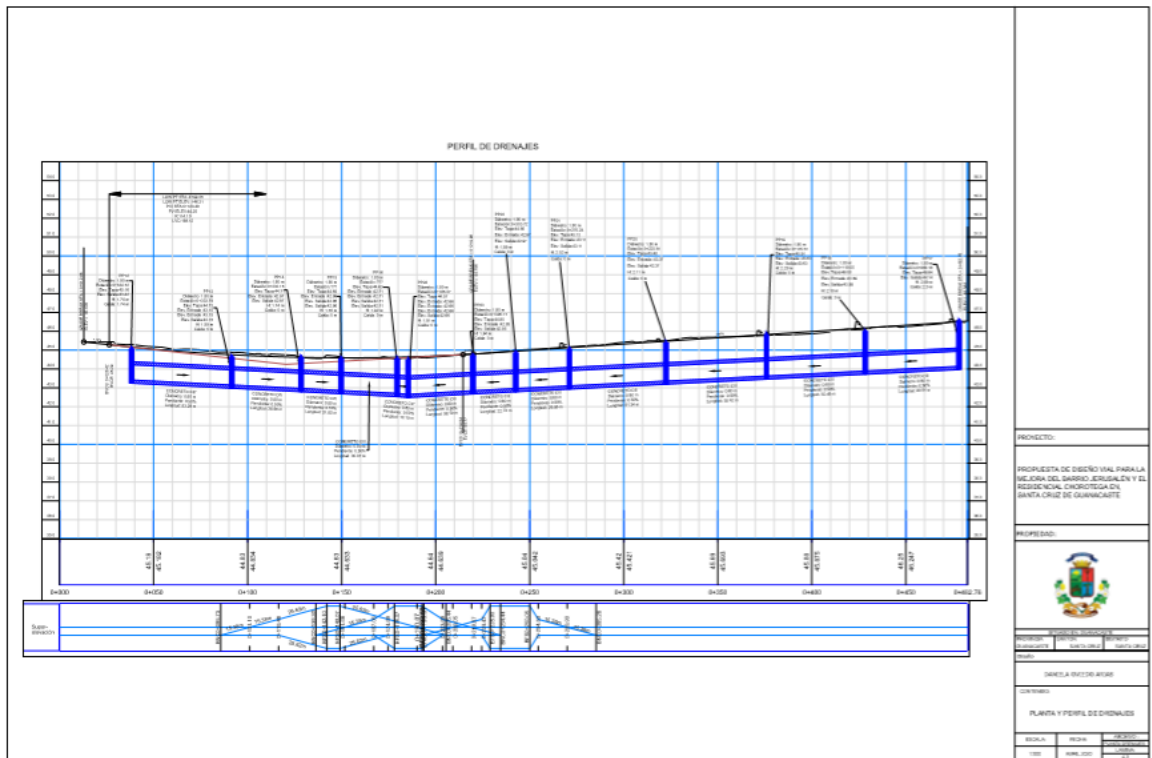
Planta y perfil calle pequeña 1 y 2
